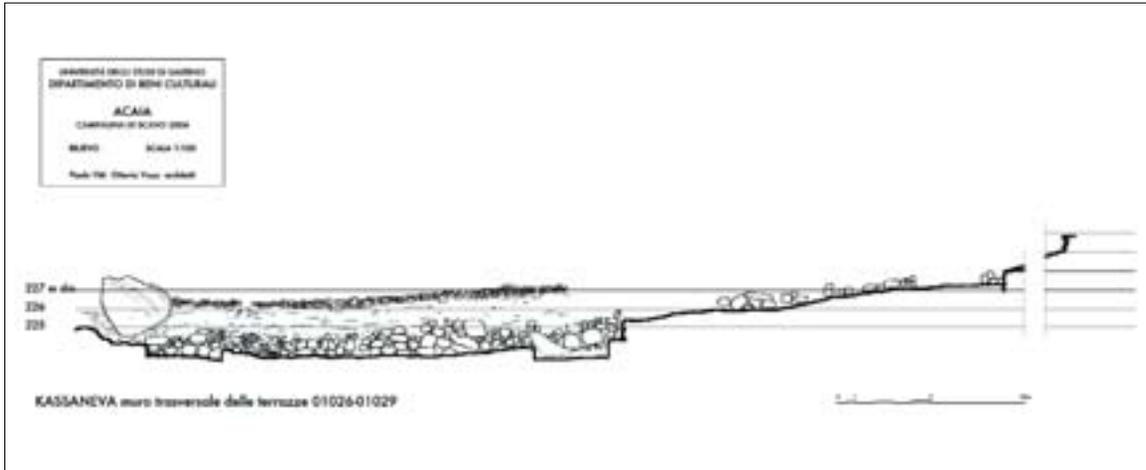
Kassaneva. Prospetto del muro di sostruzione delle terrazze 1026-1029 (Lab. Arch. 'Mario Napoli', Univ. Salerno, ril. P. Vitti, O. Voza 2004)
